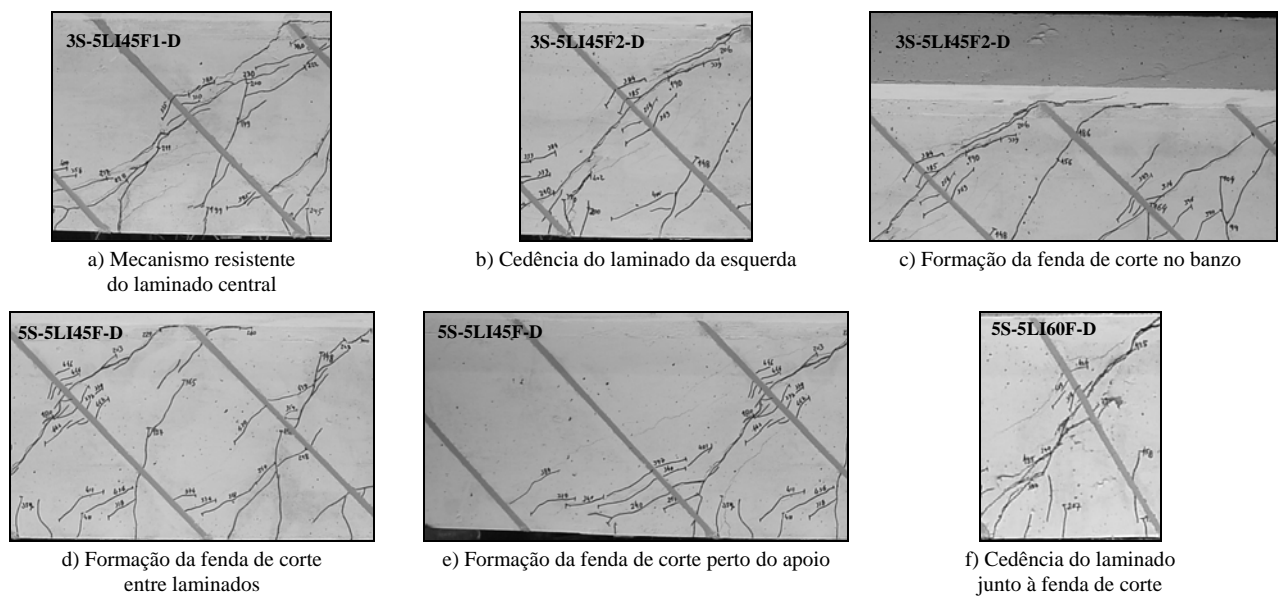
Pormenores dos ensaios das vigas com CFRP pré-fendilhadas.
